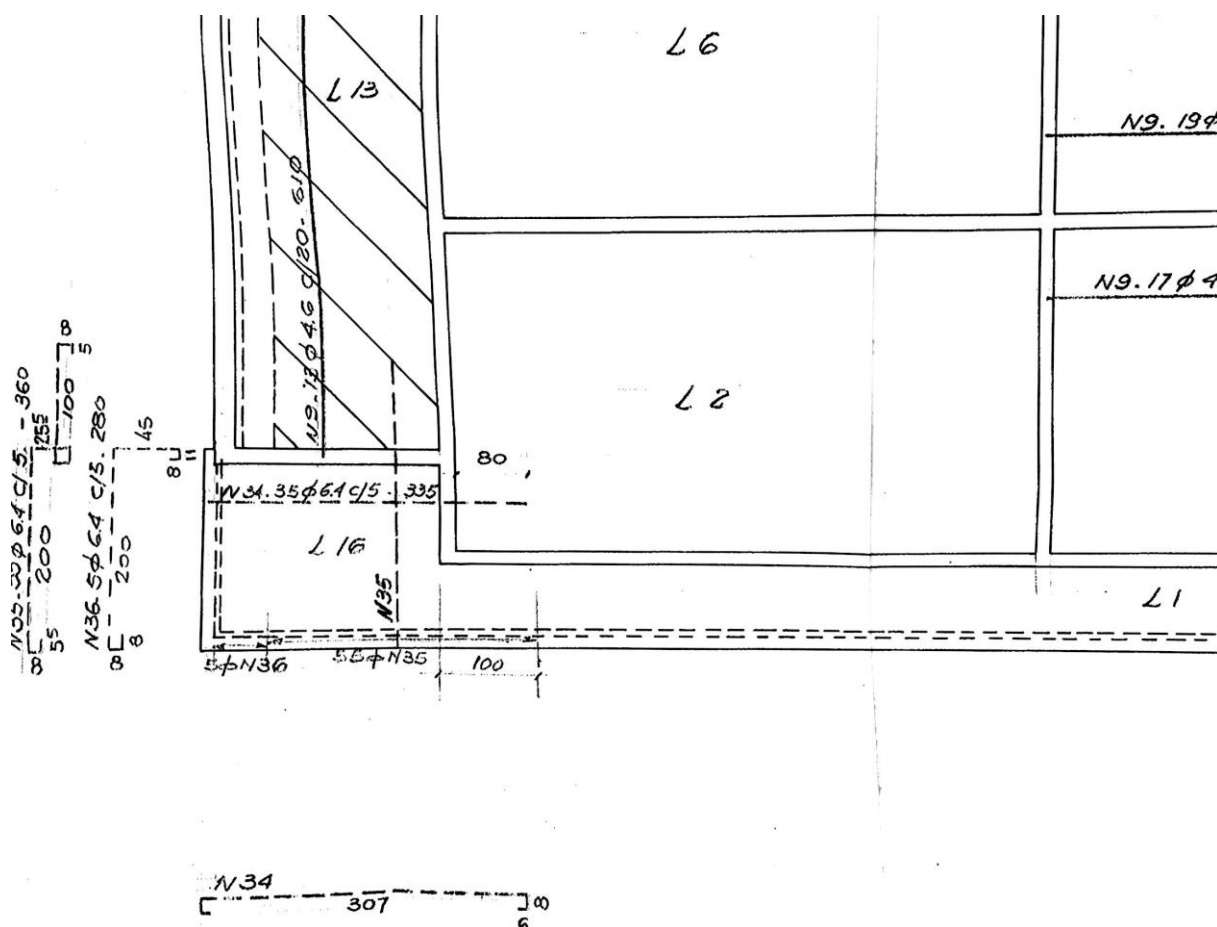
Reprodução Parcial do projeto estrutural – Armação das lajes do pav. Térreo
